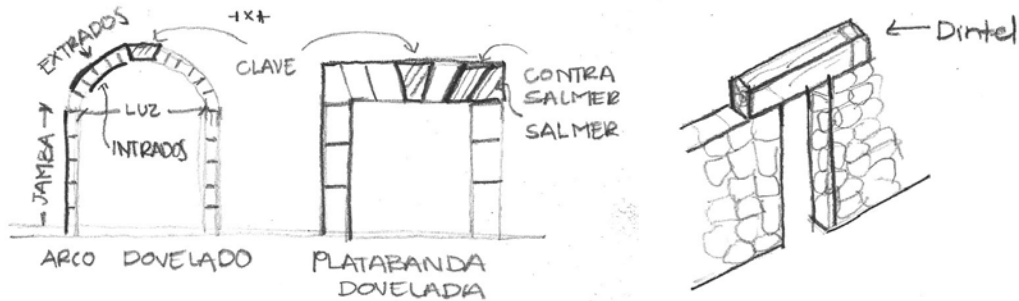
Croquis de sistema constructivo de puertas, vanos y cerramientos en la CAMEM. Elaboró: METR
